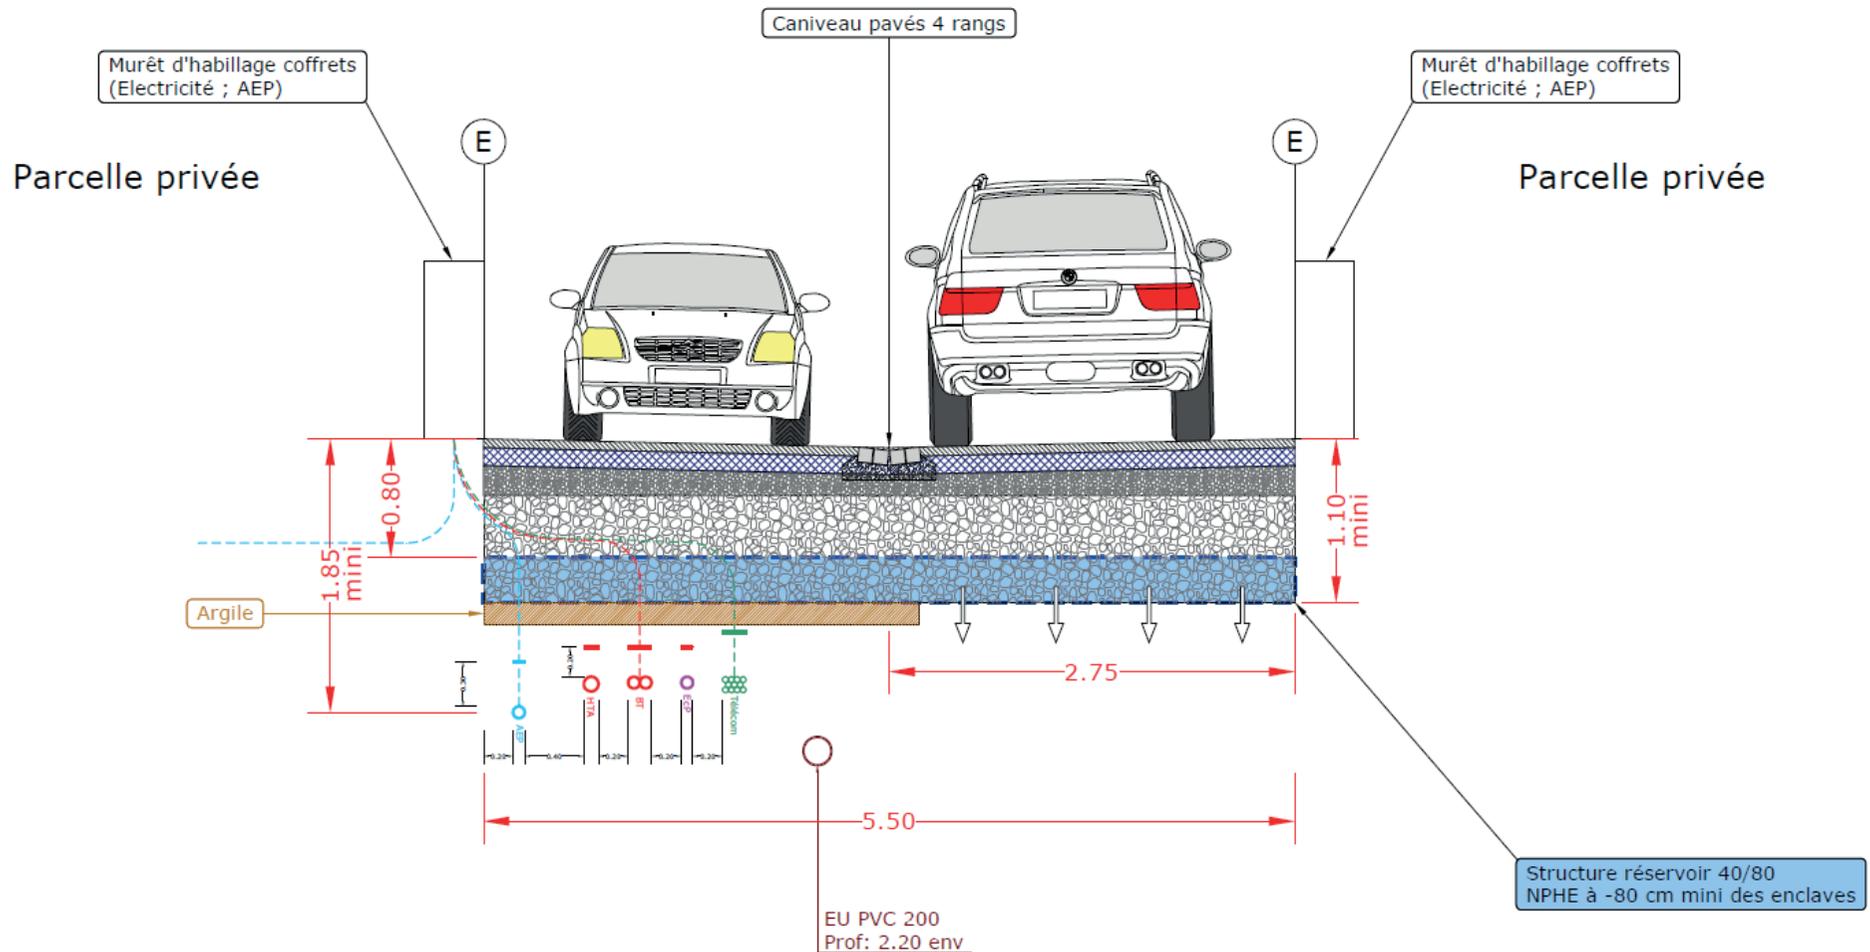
Schéma type d'une coupe de la structure réservoir d'une chaussée secondaire (exemple iao senn)
